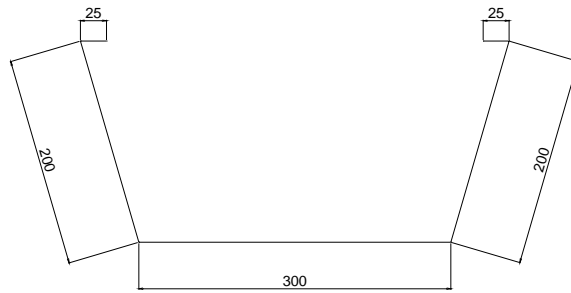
Chéneau encastré (épaisseur 1 mm)
